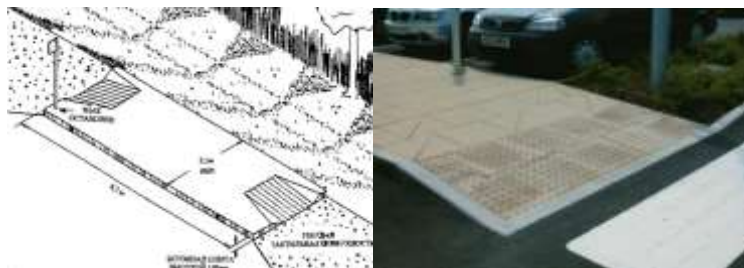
Пример оборудования посадочной площадки пандусами
